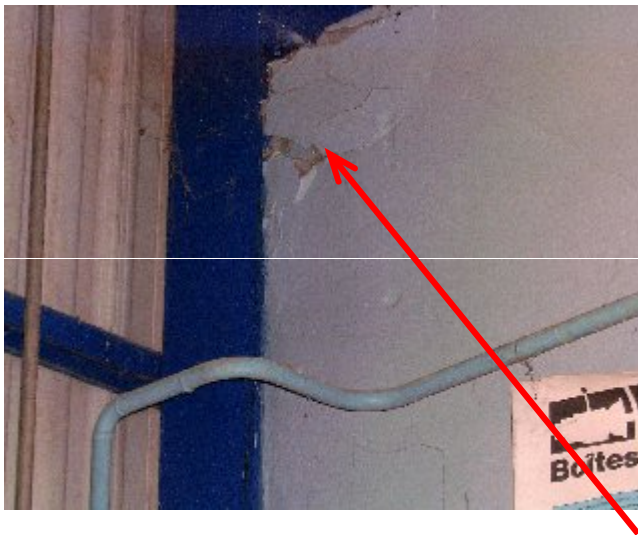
Fissurations importantes dans les murs.
